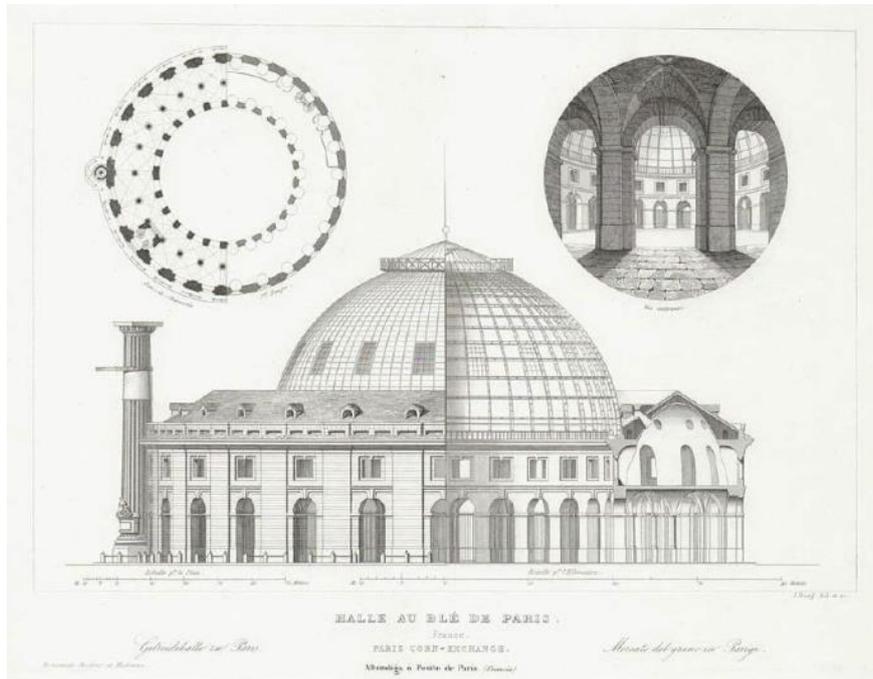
Plan en coupe de la Halle au Blé, source J. Bury (1853) [14]
